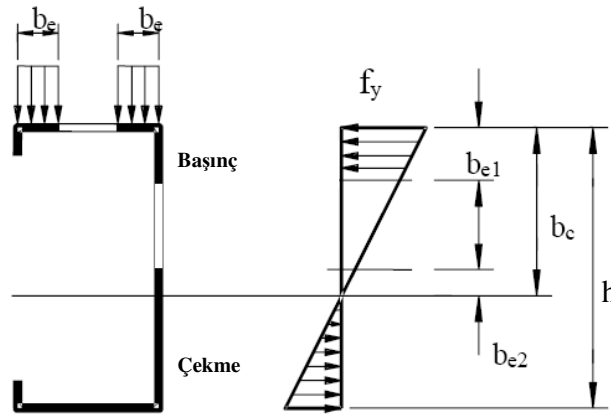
Gövde boşluklu C kesit kiriş elemanlar
